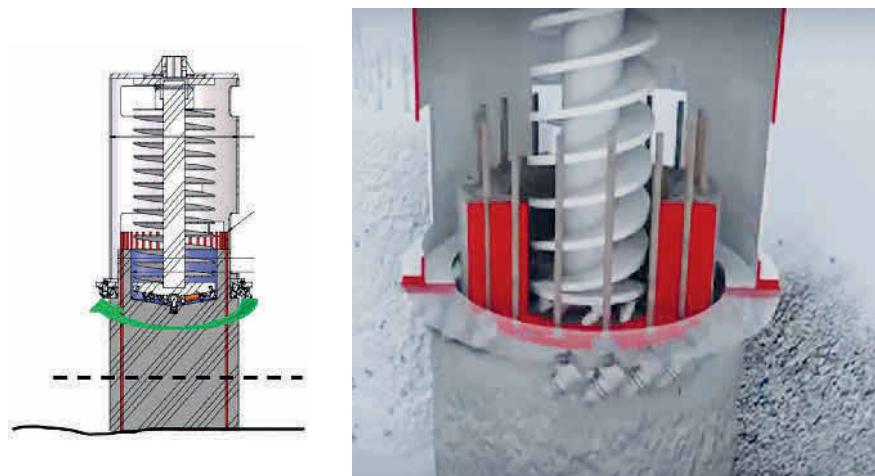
Ein Innenfräser bricht die Kernspannung des Pfahlkopfs, ein Außenfräser die Oberflächenspannung. Foto: BRC Engineering
